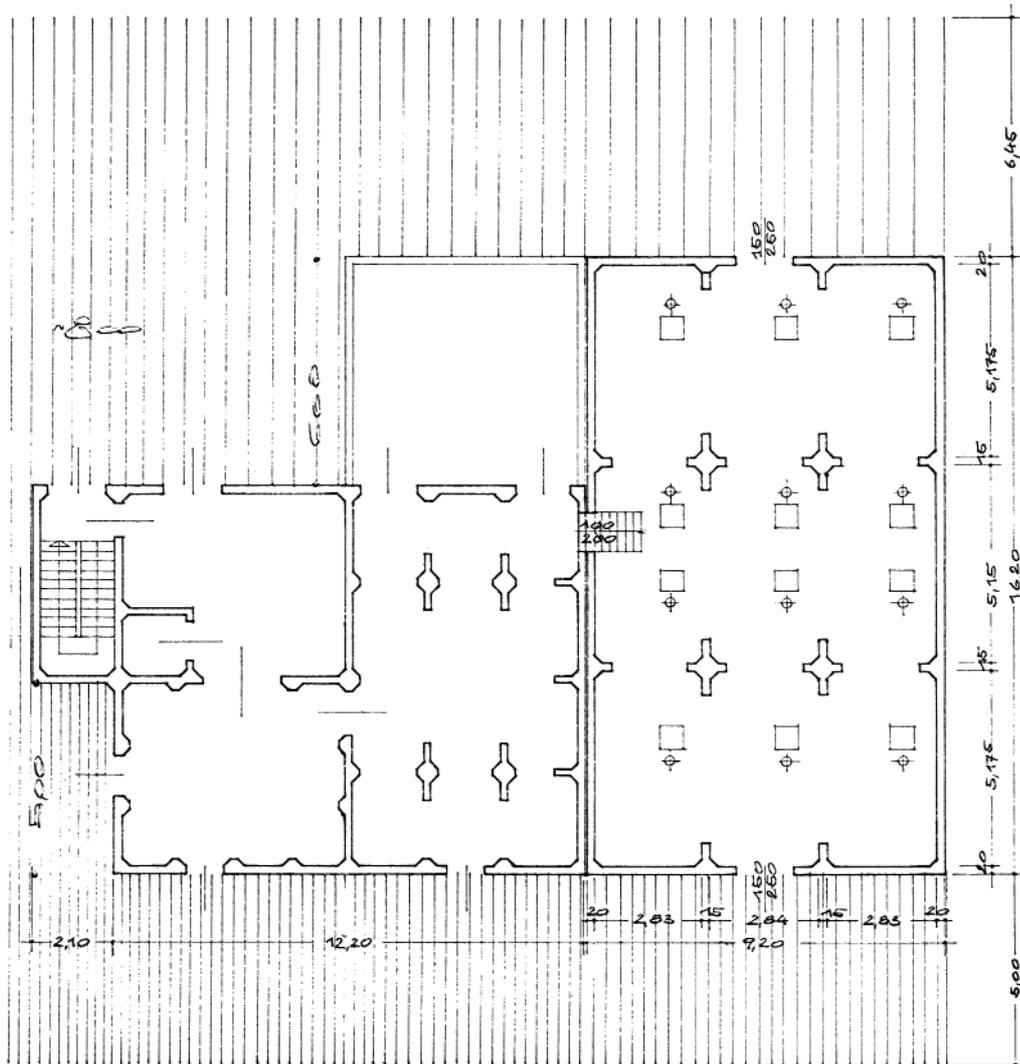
Bestandsplan - Grundrisse Silo
